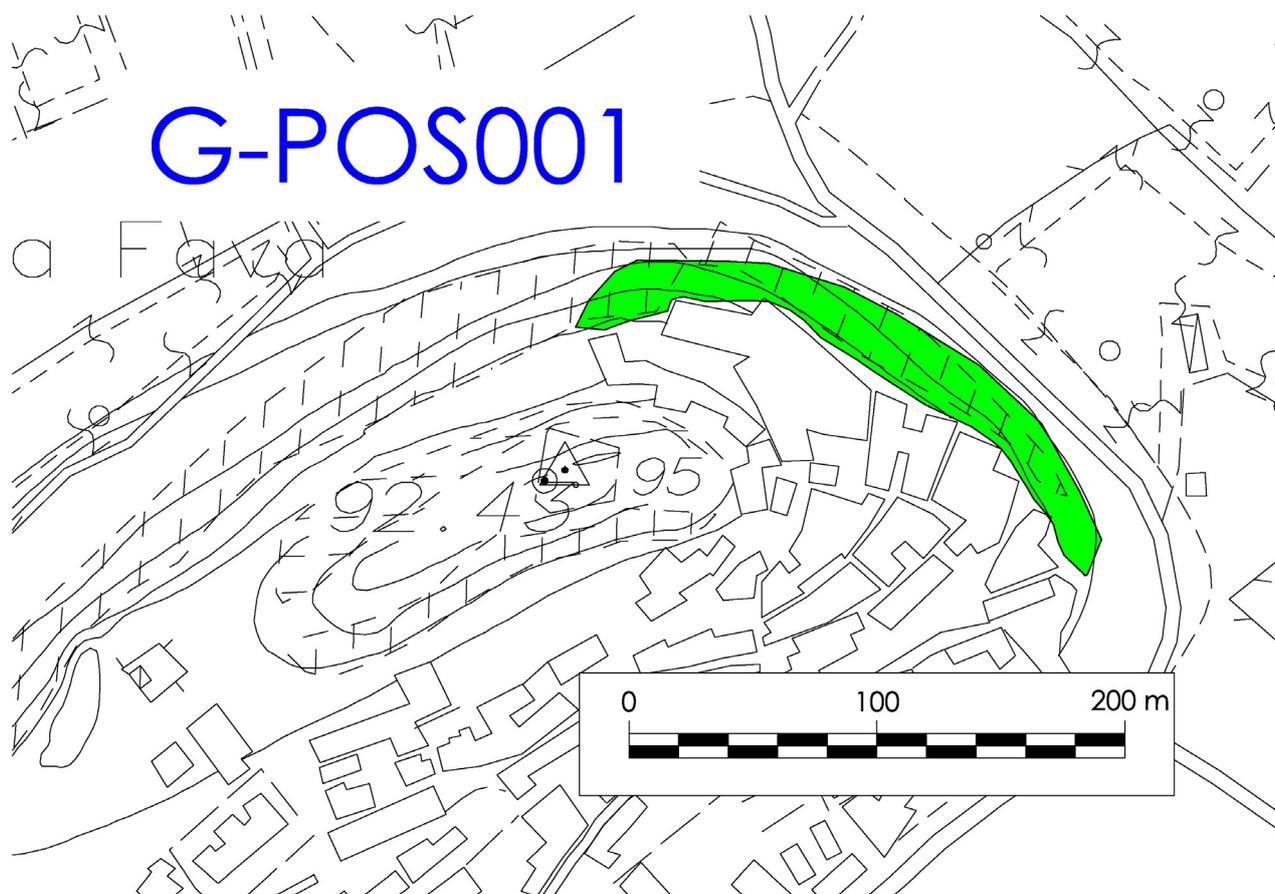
Comune di Posada – Planimetria interventi mitigazione rischio franoso
